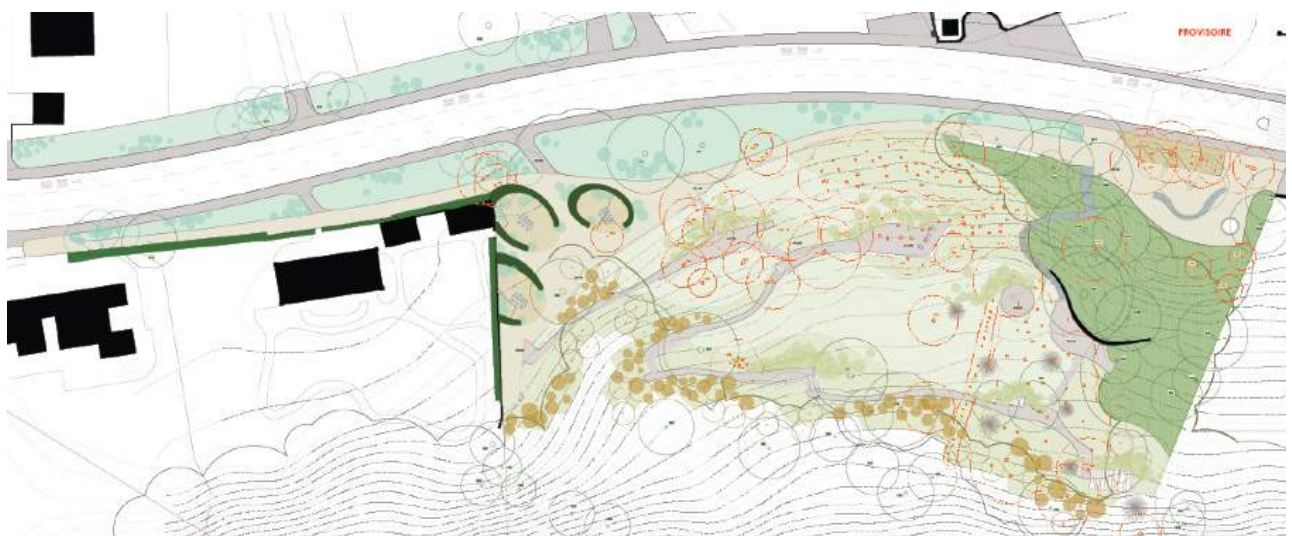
Plan masse par l'atelier paysage et architecture (apaar)
